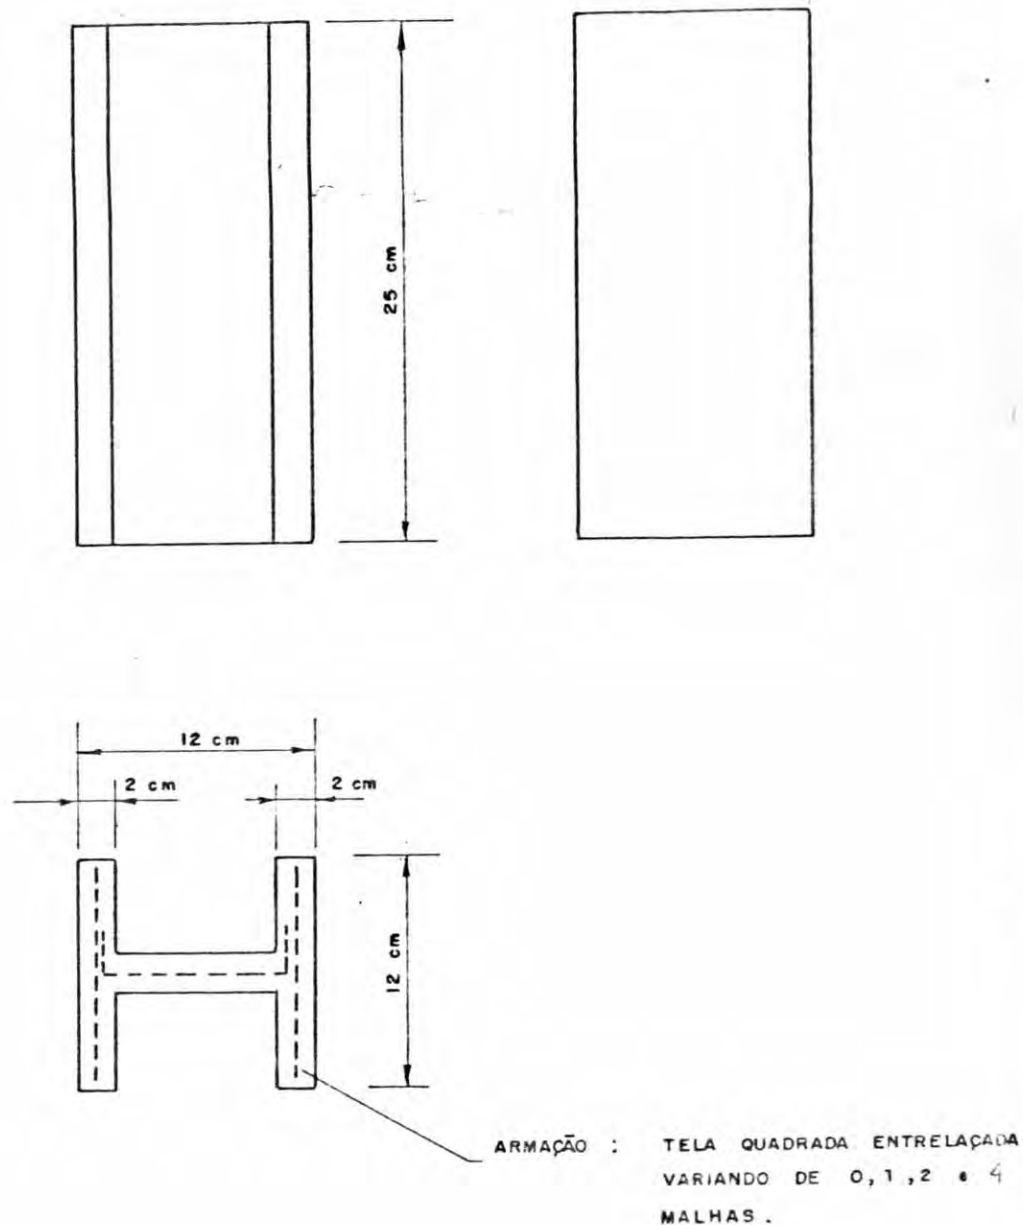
CORPOS DE PROVA DE SEÇÃO H, PARA RUPTURA À COMPRESSÃO.
